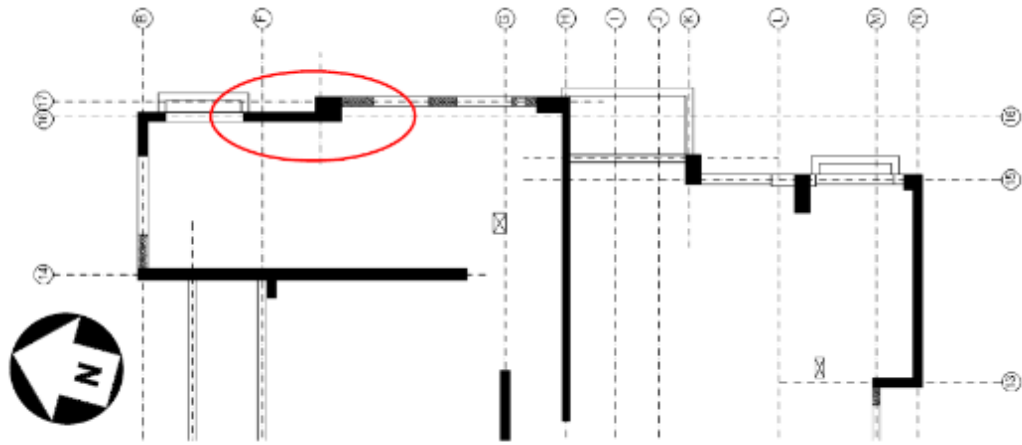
Ubicación muro dañado primero piso eje 16 [18]
